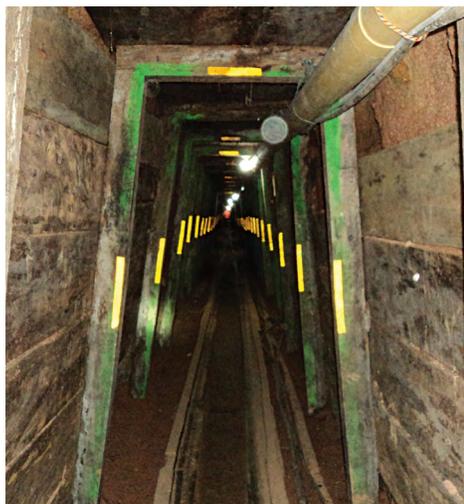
Inclinado para acceso a los niveles de trabajo. Fuente: autores.
